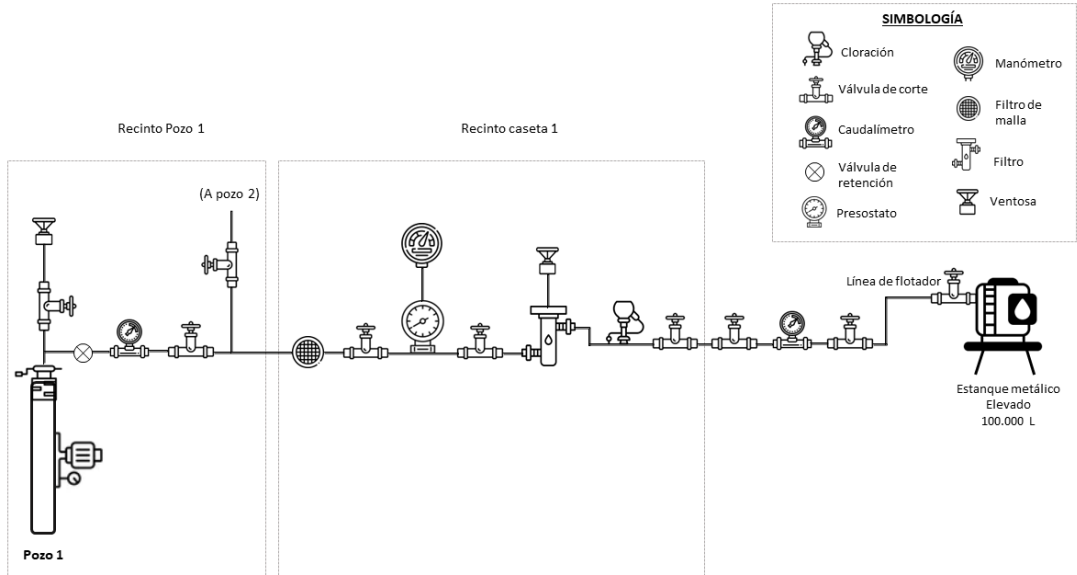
Layout sistema pozo 1 APR Villaseca. Elaboración propia.
